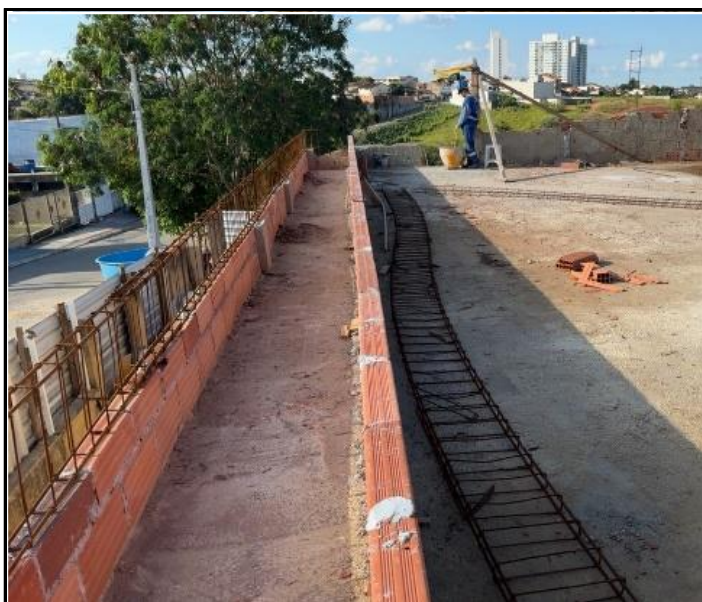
Montagem de Aço e Forma para reforço estrutural em viga de platibanda.
